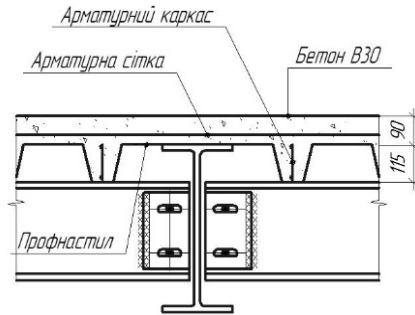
Поперечний переріз плити покриття вертолітного майданчика на даху будівлі
